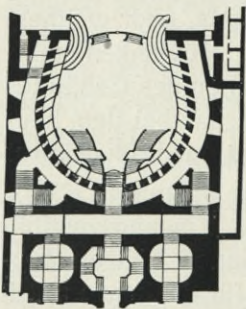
Theater San Carlo zu Neapel. Grundriß des Zuschauerhauses.
